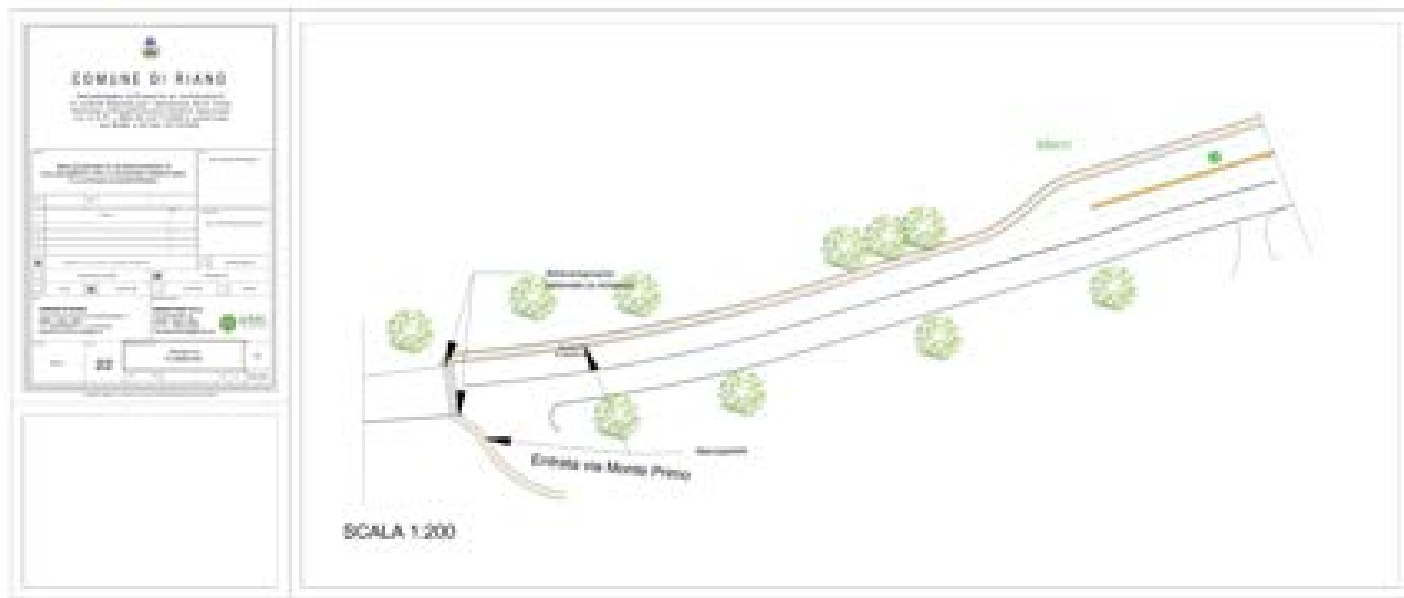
B22: planimetria di progetto con tracciato del marciapiede e attraversamento pedonale a richiesta.
